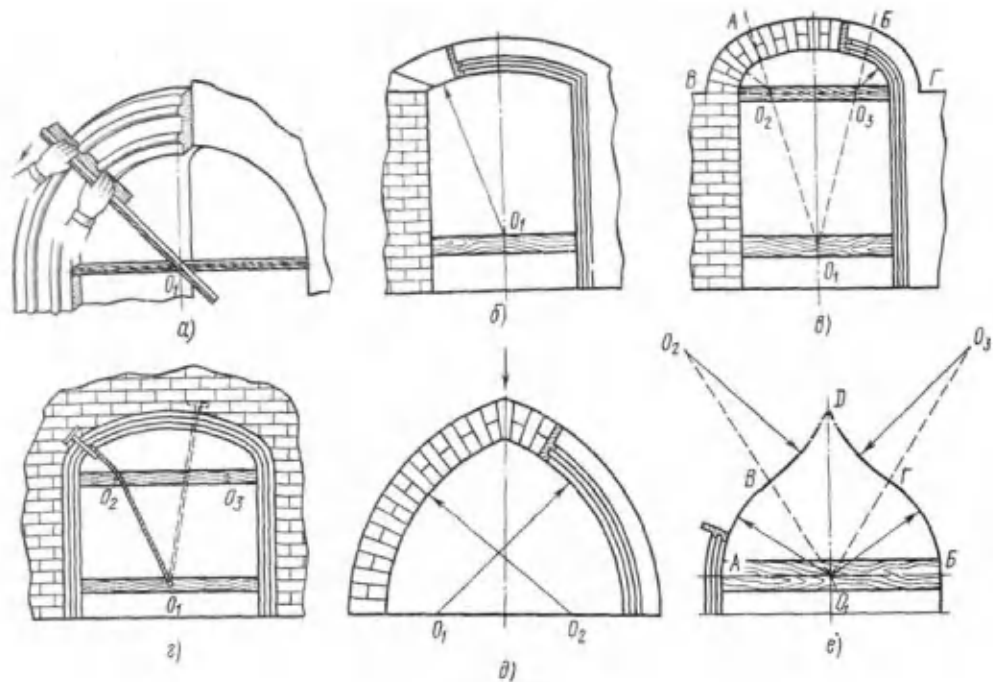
Вытягивание арок: полуциркульной, б — пологой, в — коробовой из трех центров, г — коробовой из одного центра, д — простой стрельчатой, е — сложной стрельчатой
